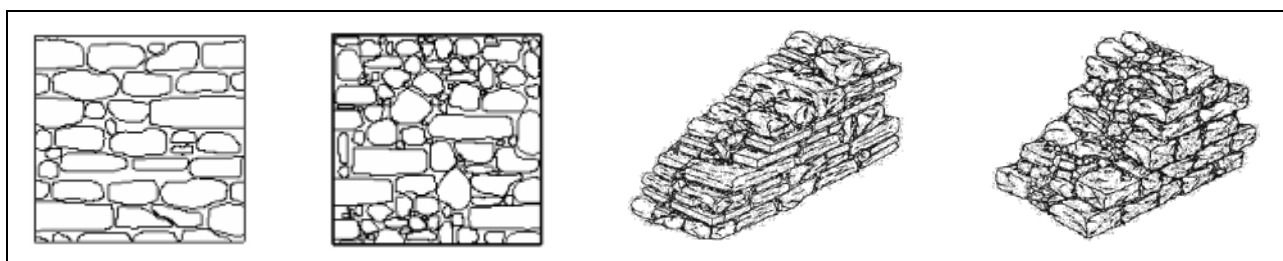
Tipo de assentamento e aparelho das alvenarias de pedra irregular [3]
